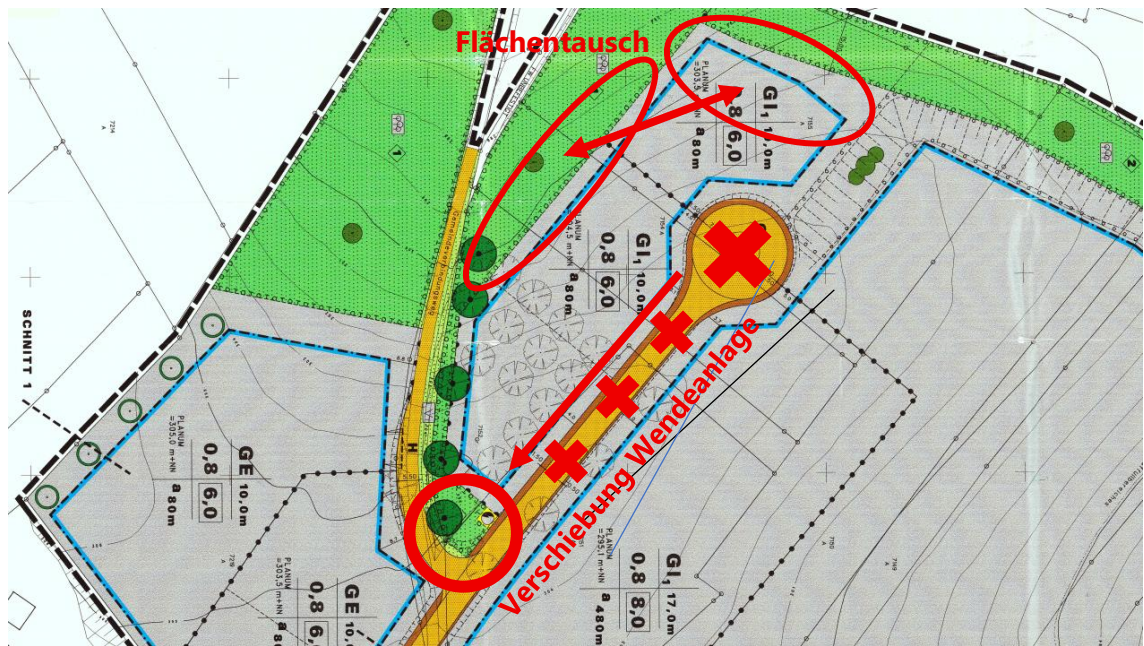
Skizze der wesentlichen Planänderungen (eigene Darstellung)
